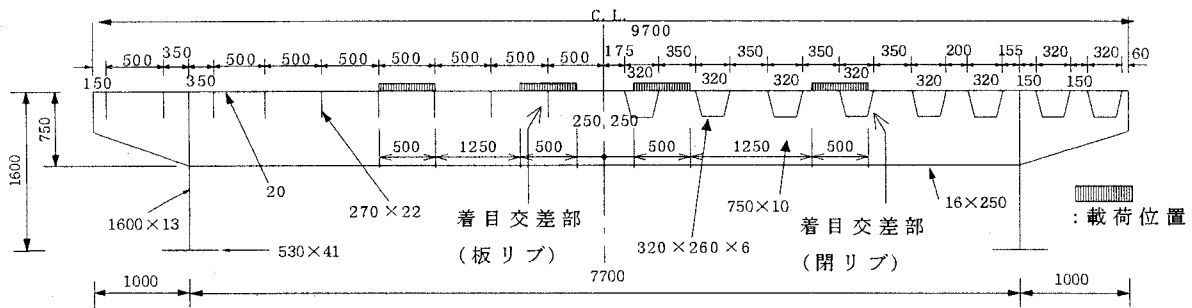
合理化鋼床版桁橋断面図 (左:板リブモデル 右:閉リブモデル) (mm)
